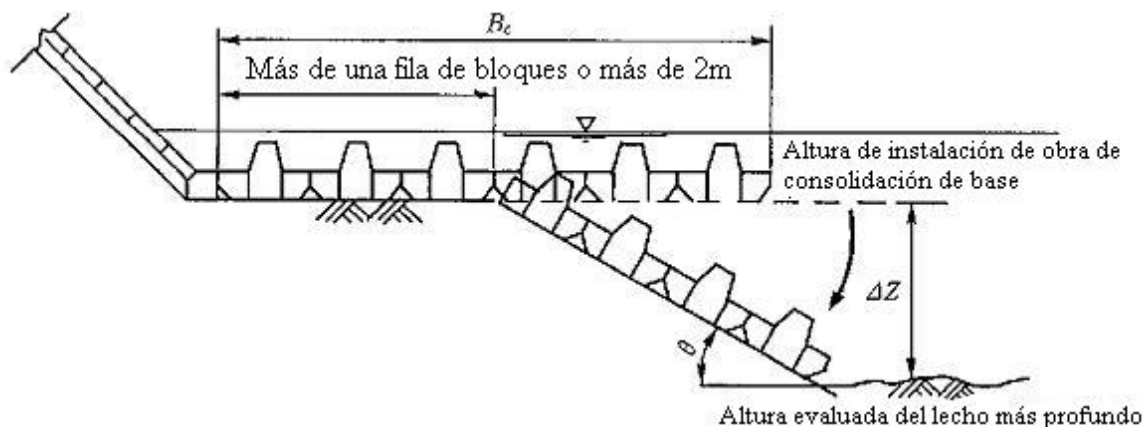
Ancho de instalación de obra de consolidación de la base
